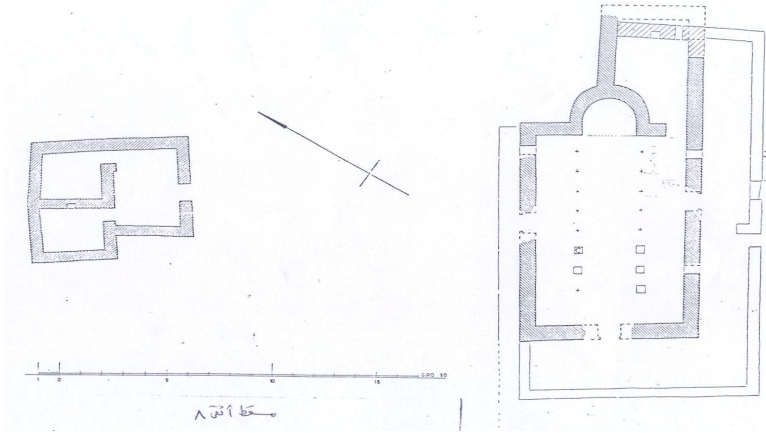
مسقط أفقي لكاتدرائية فيران. نقلاً عن.
